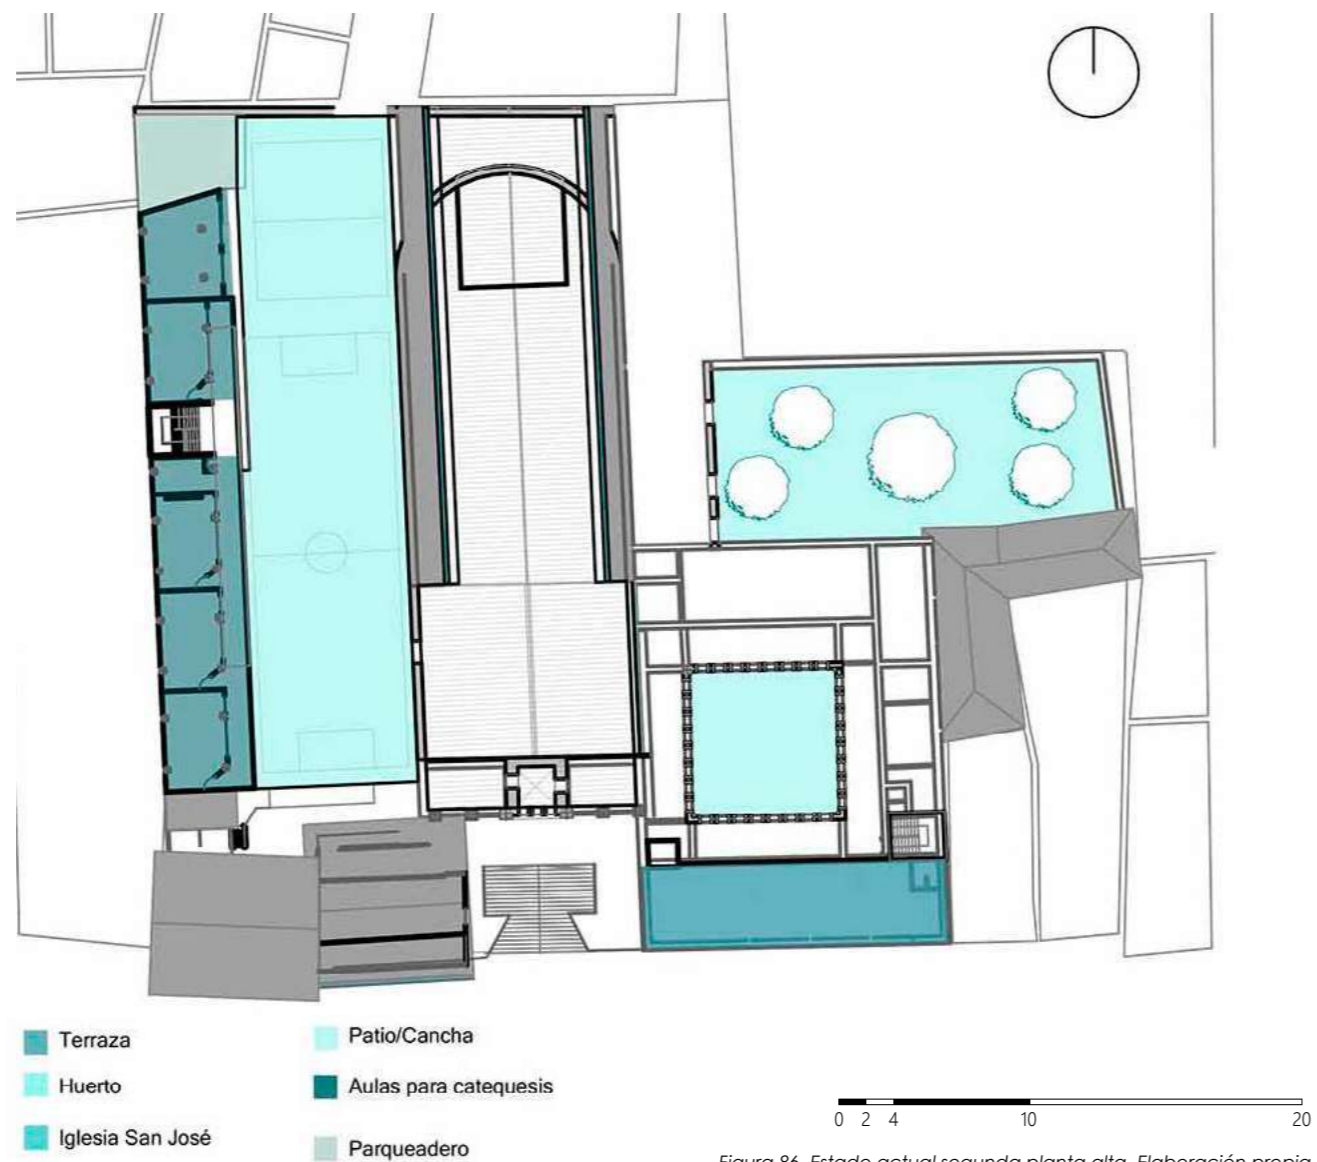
Estado actual segunda planta alta. Elaboración propia.
